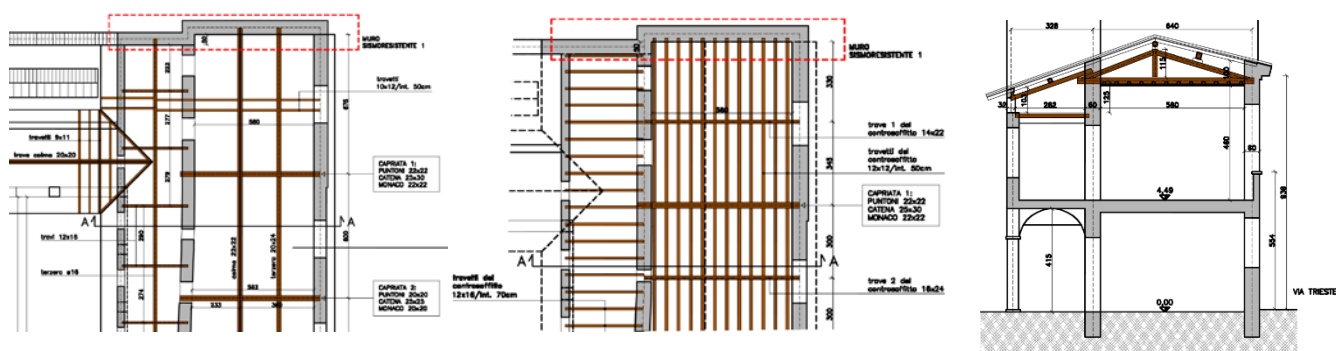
Schema strutturale tetto e controsoffitto zona A (zona ovest)
